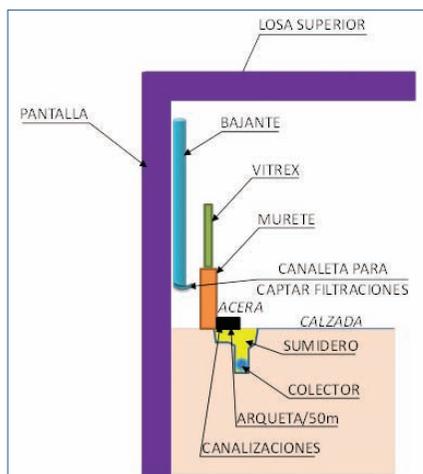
Esquema de la solución de drenaje lateral en los Túneles de Calle 30.
